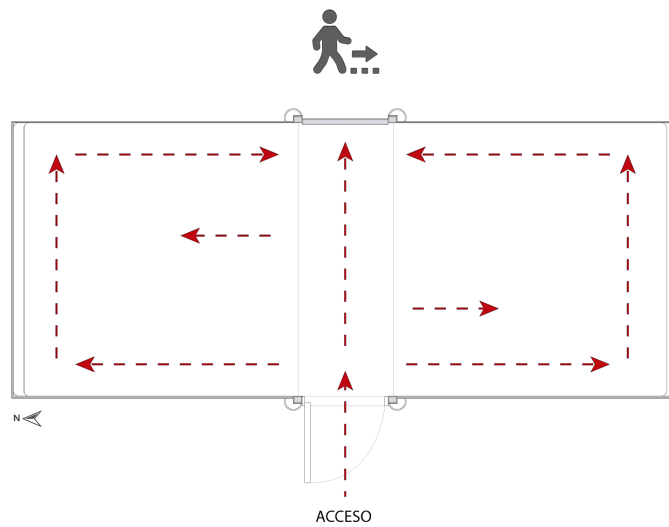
Circulación en planta libre Cmax System. Elaboración: Los Autores.
